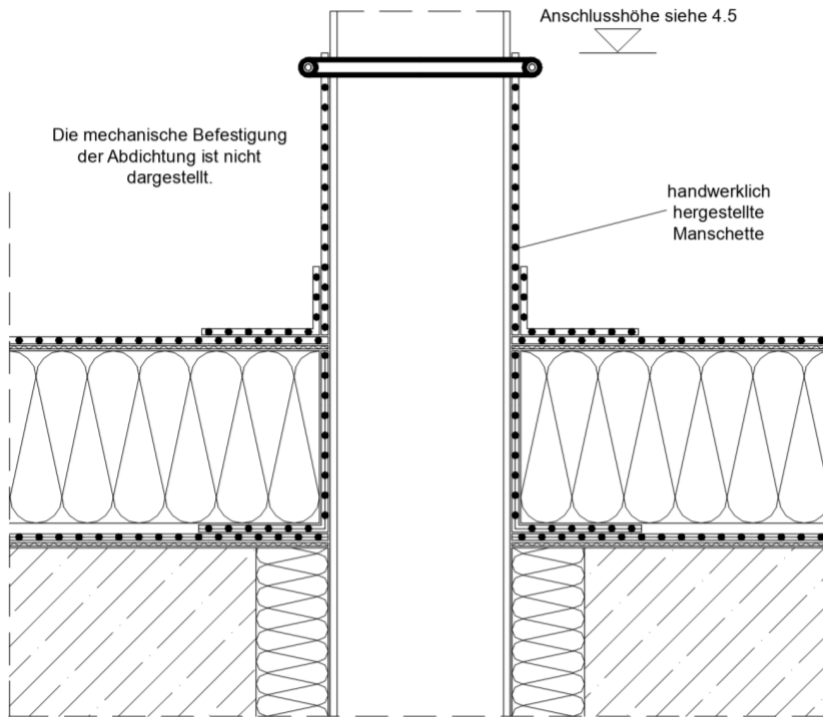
Anschluss an Rohrdurchführung – Ausführung mit Flüssigkunststoff
